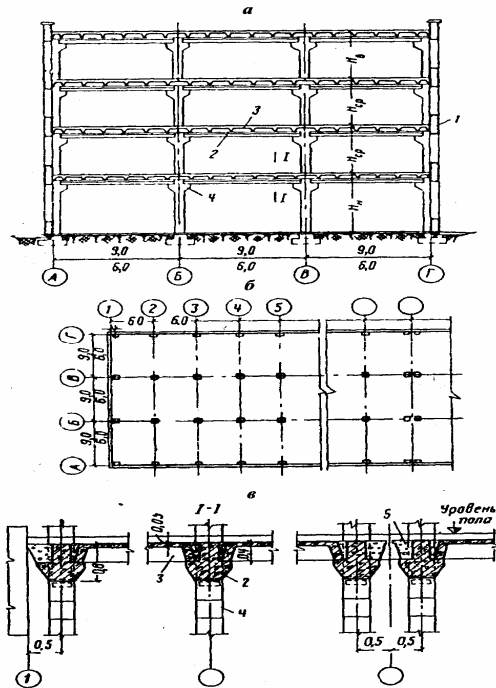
Многоэтажное здание с балочными перекрытиями:
